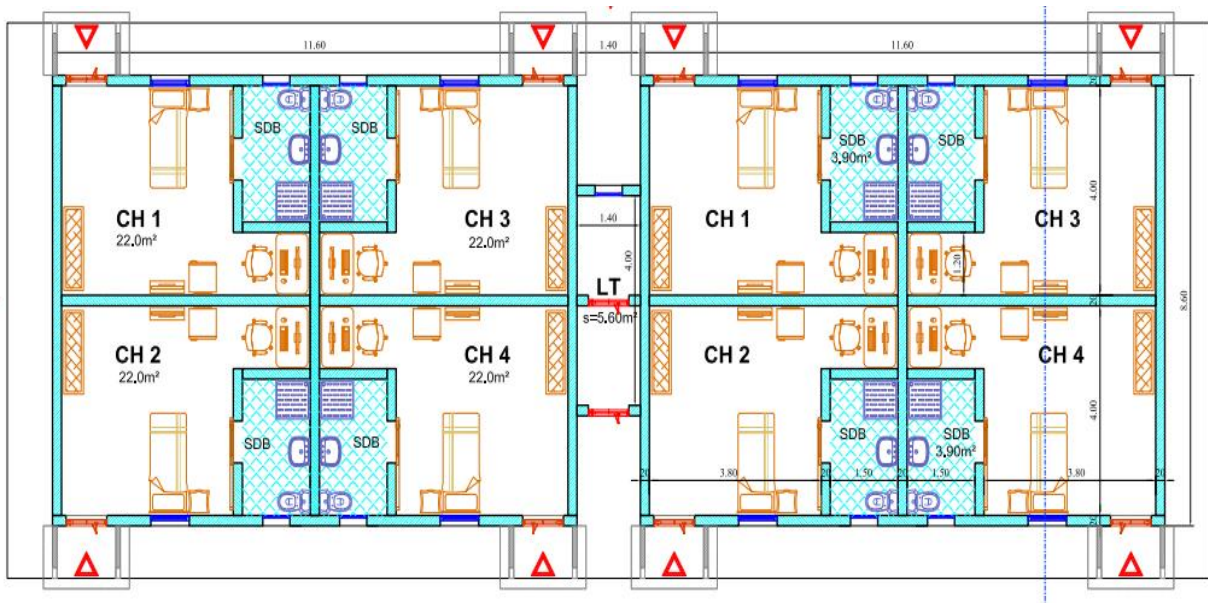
Plan du BLOC A Situé à GASSI TOUIL
